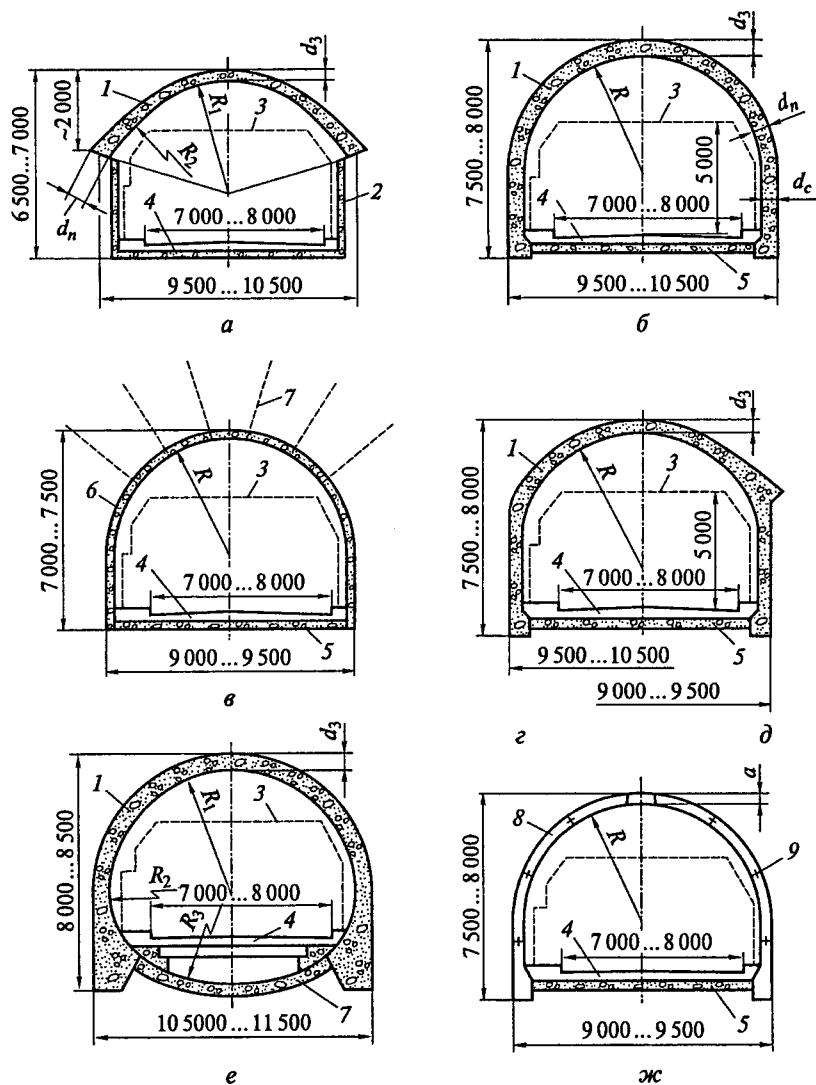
Конструкции (а—ж) тоннельных обделок сводчатого очертания:
